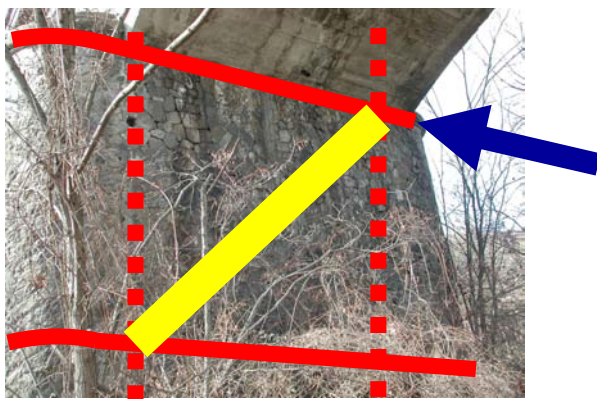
d. Il sistema preposto ad assorbire l'azione sismica orizzontale sulle pile è costituito da pali infissi dal piano stradale al terreno fondale (punteggiata) e da cinture in composito incollate esternamente alla testa e alla base delle pile (linea solida più sottile). L'ideale biella diagonale muraria (linea solida forte) chiude il sistema di forze.
